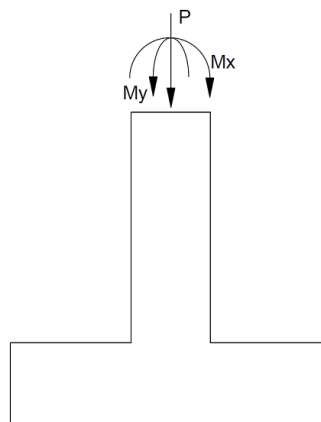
DCL Plinto de las columnas de la estructura soportante.
